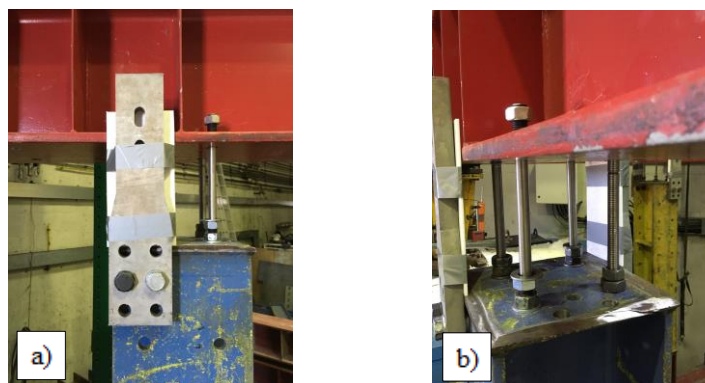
Imagens de pormenor: a) Apoio metálico confinante com placa de teflon; b) Guias.
